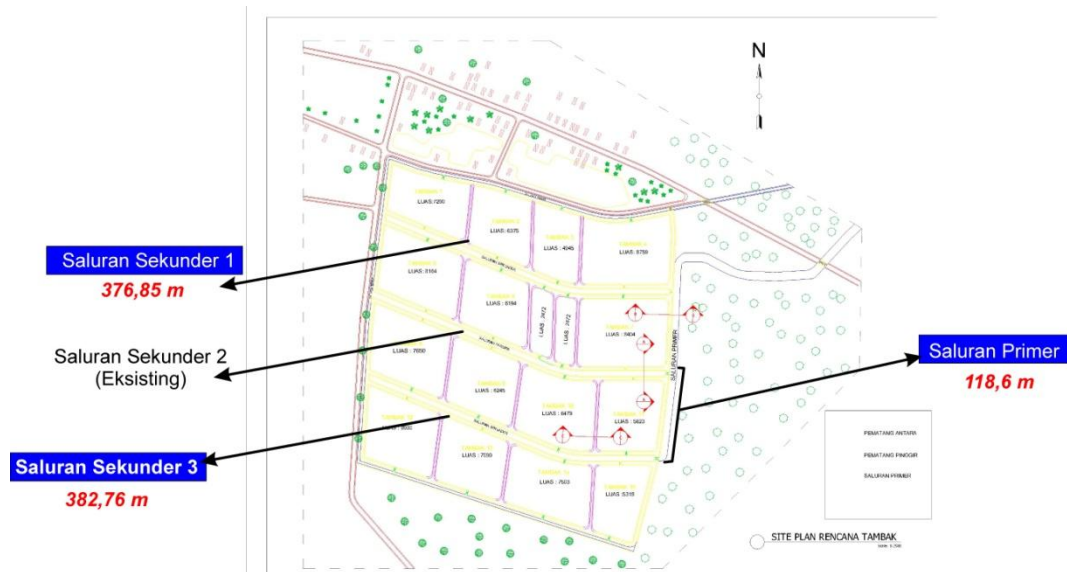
Site plan revitalisasi tambak di Desa Watuondo – Basemap Citra Satelit (Alternatif 1).
